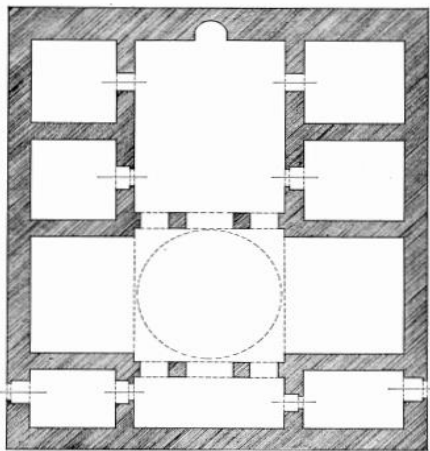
مسقط أفقي لجامع الوزير بايزيد باشا بمدينة
